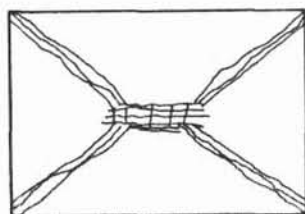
Fissuras na face inferior de uma laje simplesmente apoiada com carga uniformemente distribuída.
